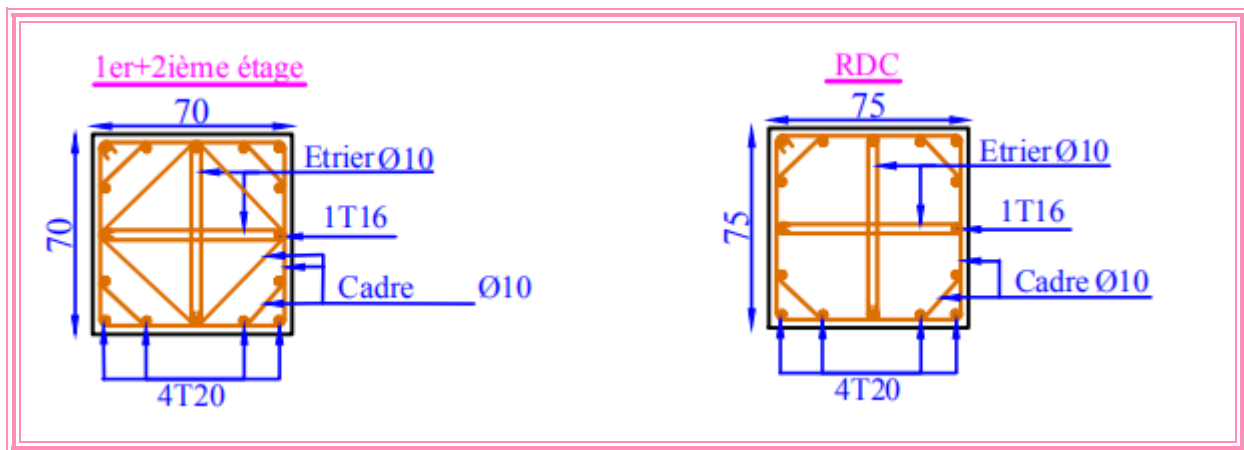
Schémas de ferrailage des poteaux de RDC et étage 1+2
